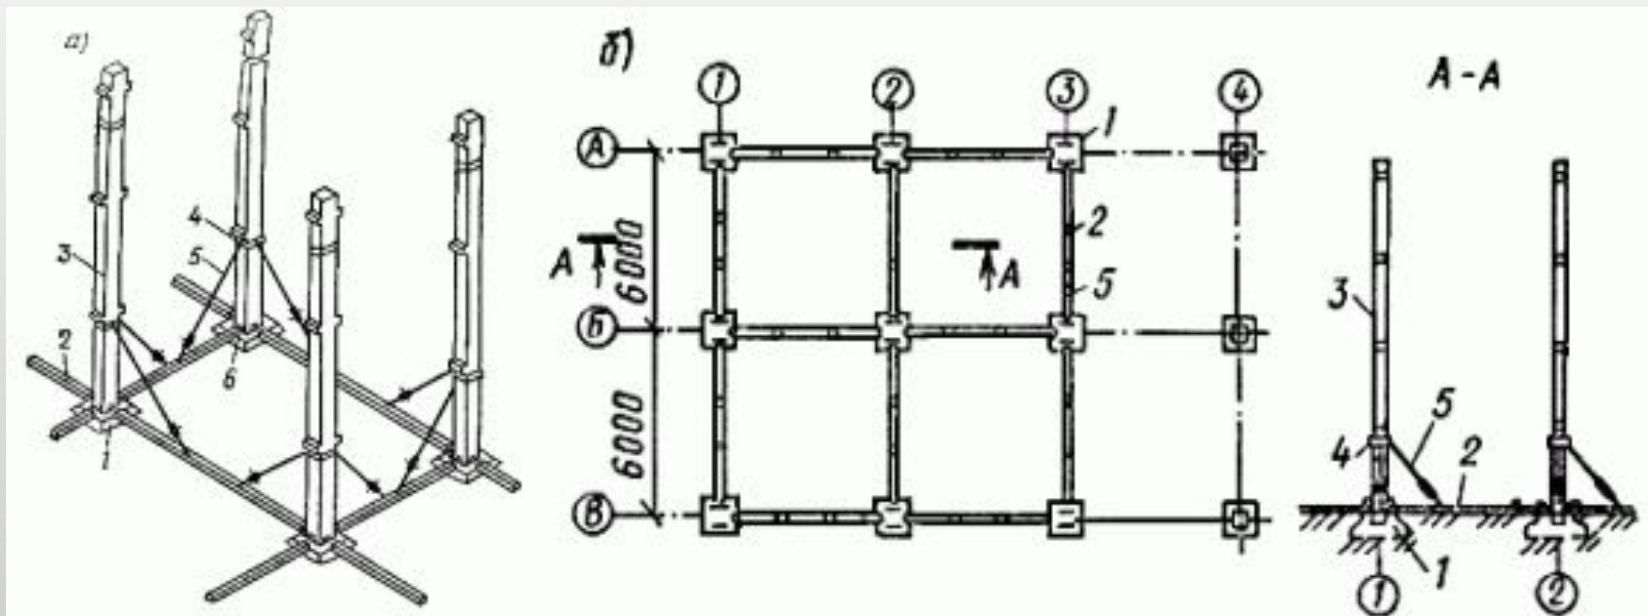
а - схема закрепления колонн с помощью подкосов; б - установка колонн
